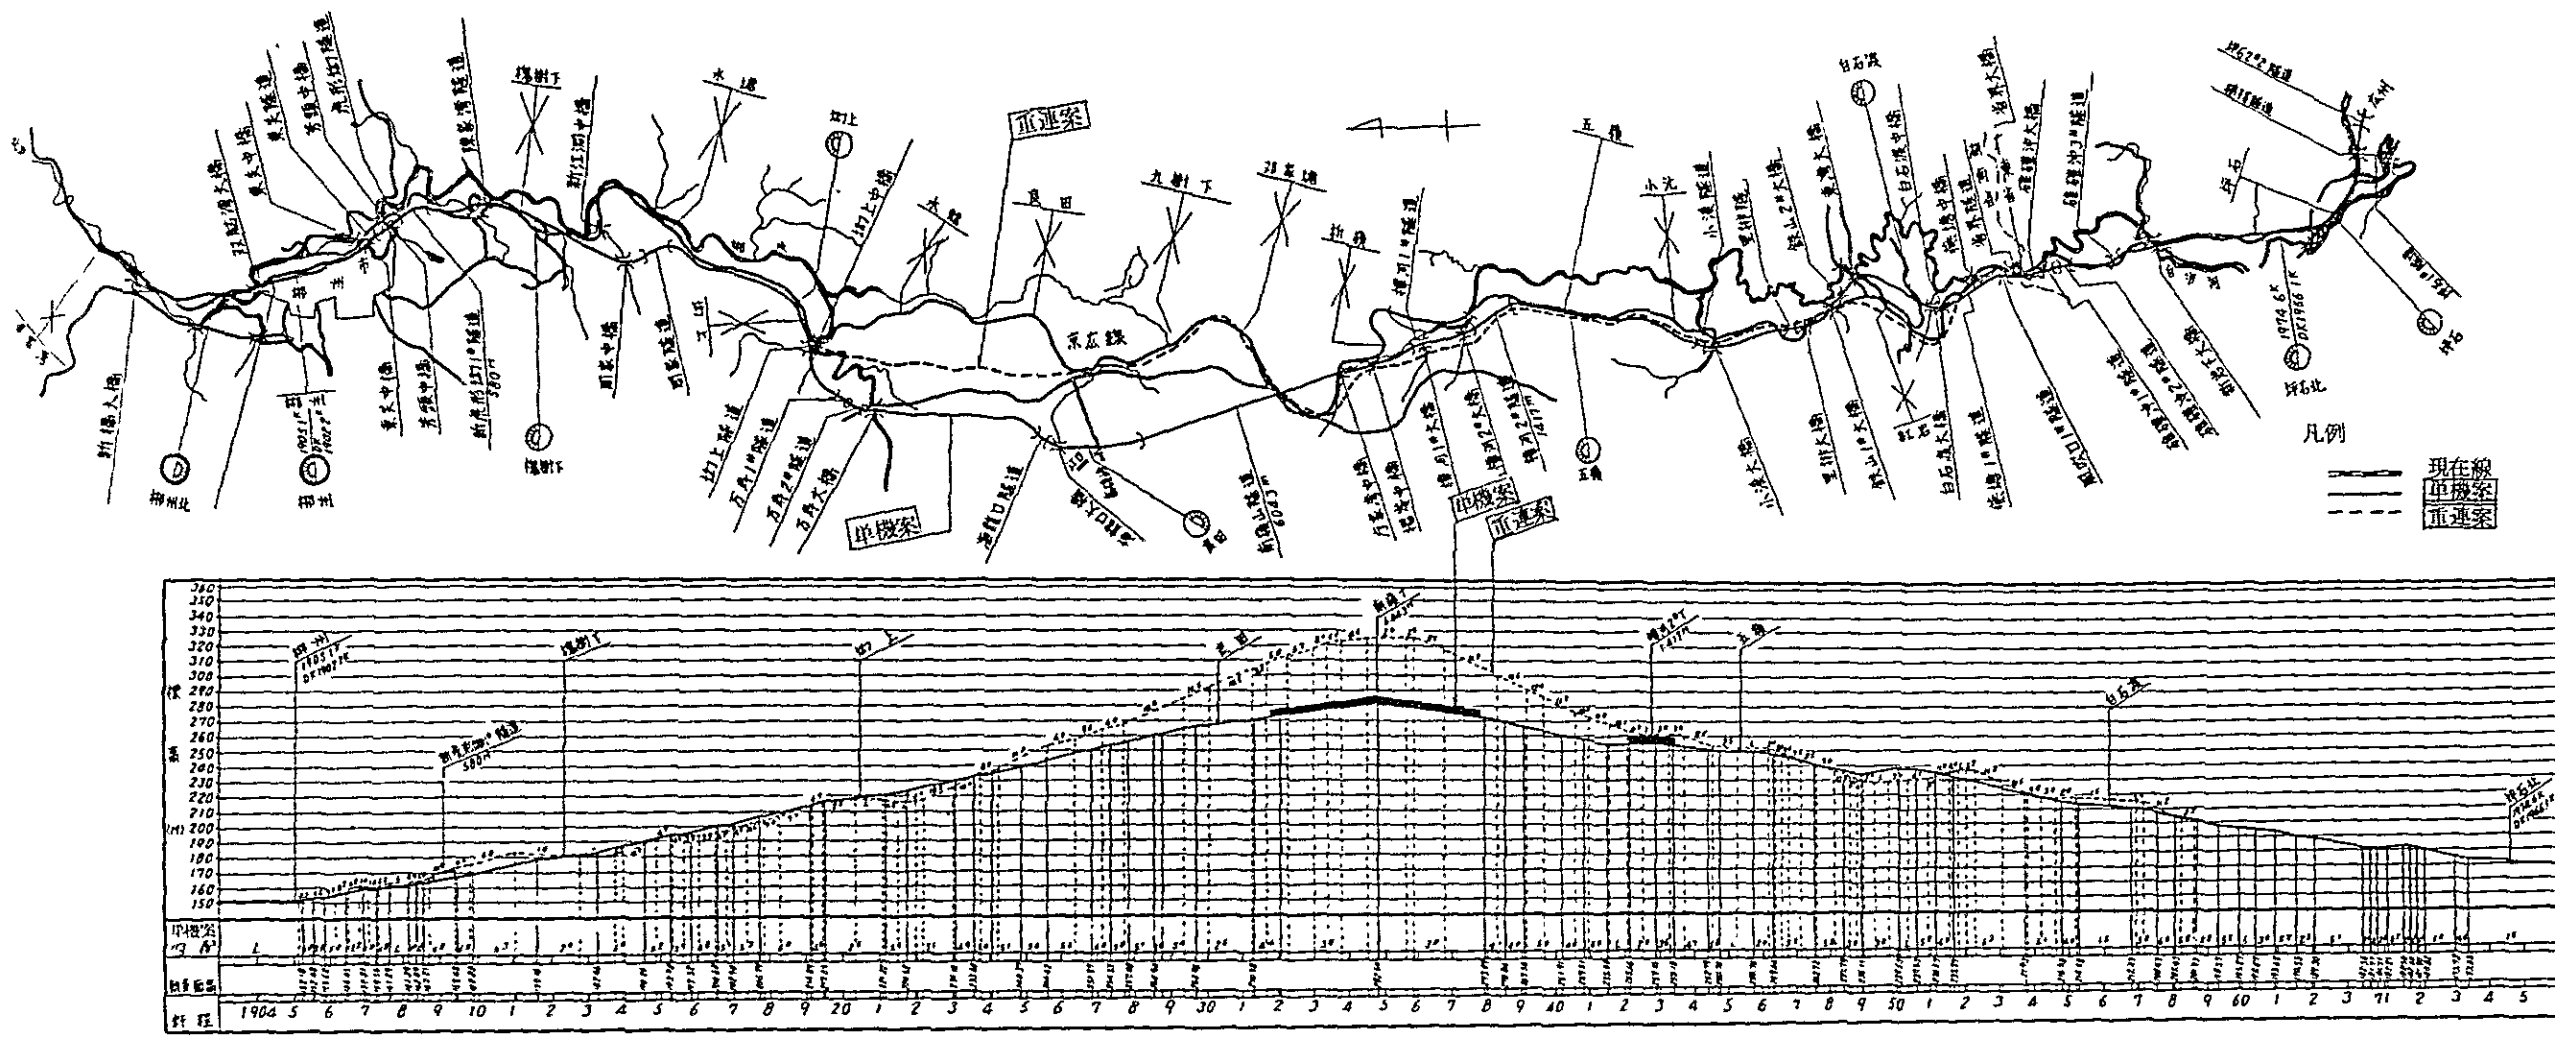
柳州·坪石間線路選定比較平面·縱断面图
